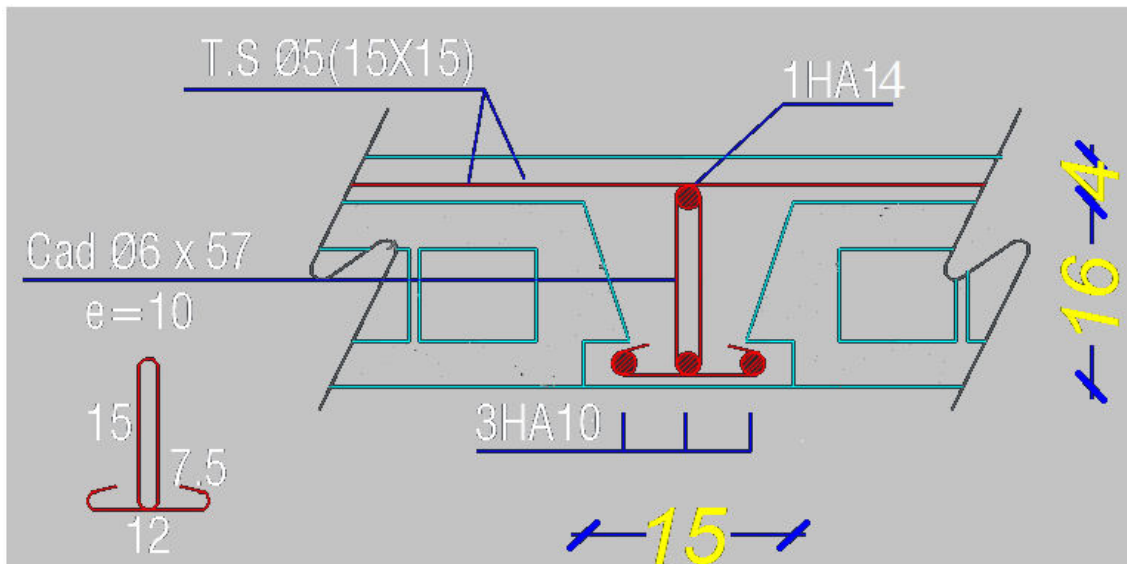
Disposition des armatures dans la poutrelle type 2 (travée)
